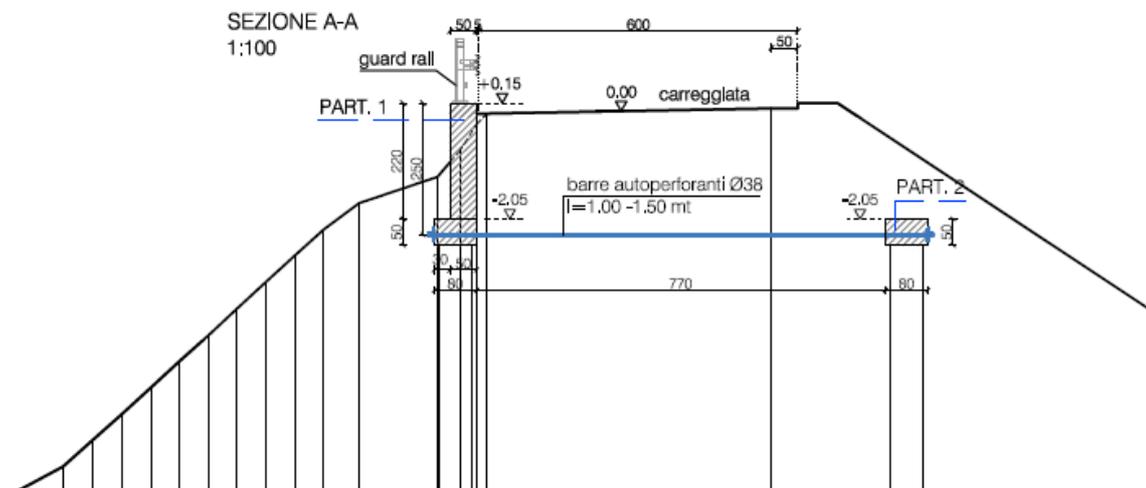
Sezione Tipo Paratia – cordoli e muro
